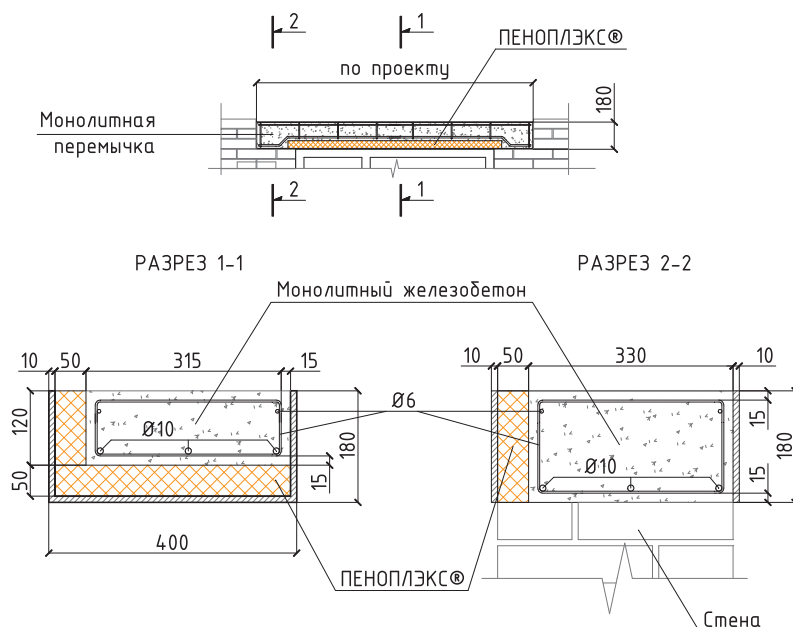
Схема теплоизоляции оконных и дверных перемычек.
